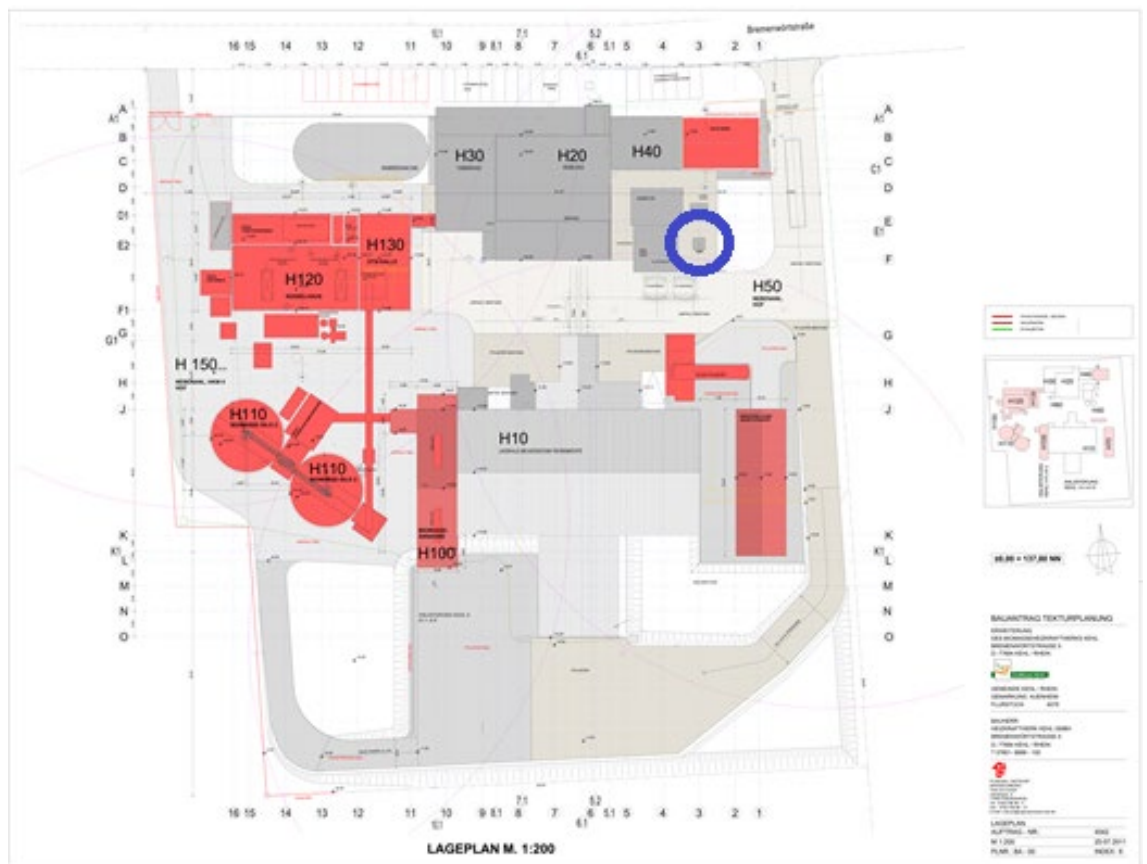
Lageplan der Anlage [34]. Lage des Schornsteins blau markiert.
